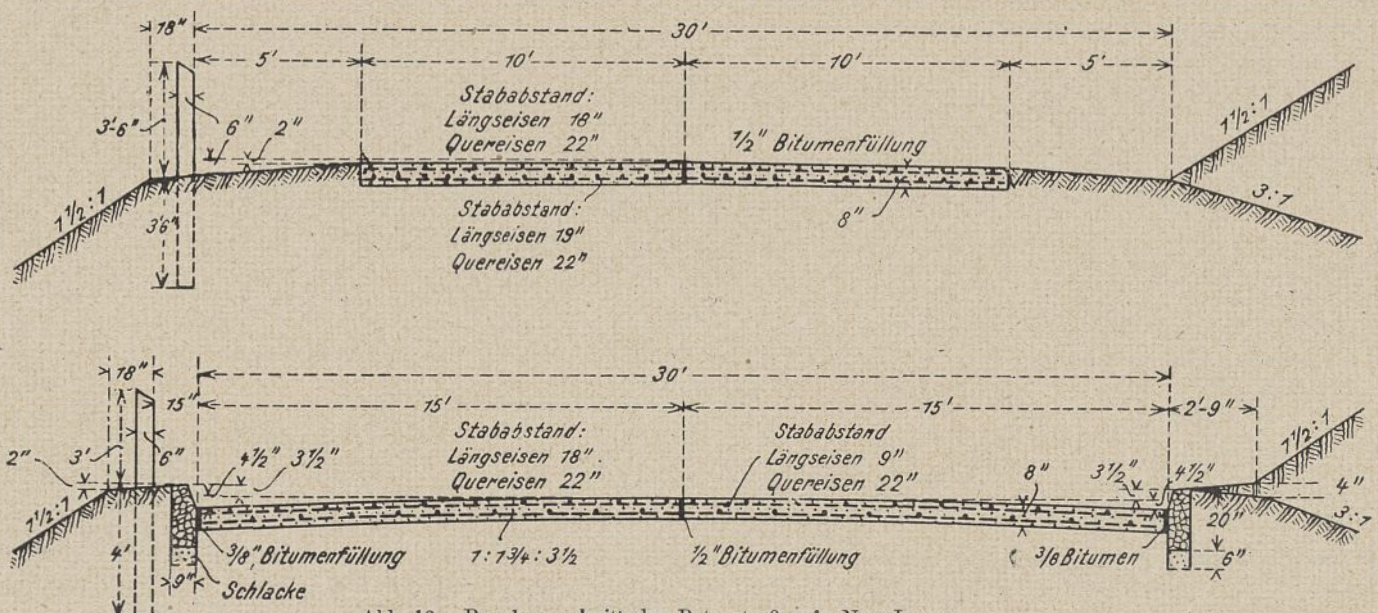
Regelquerschnitt der Betonstraßen in New-Jersey.
